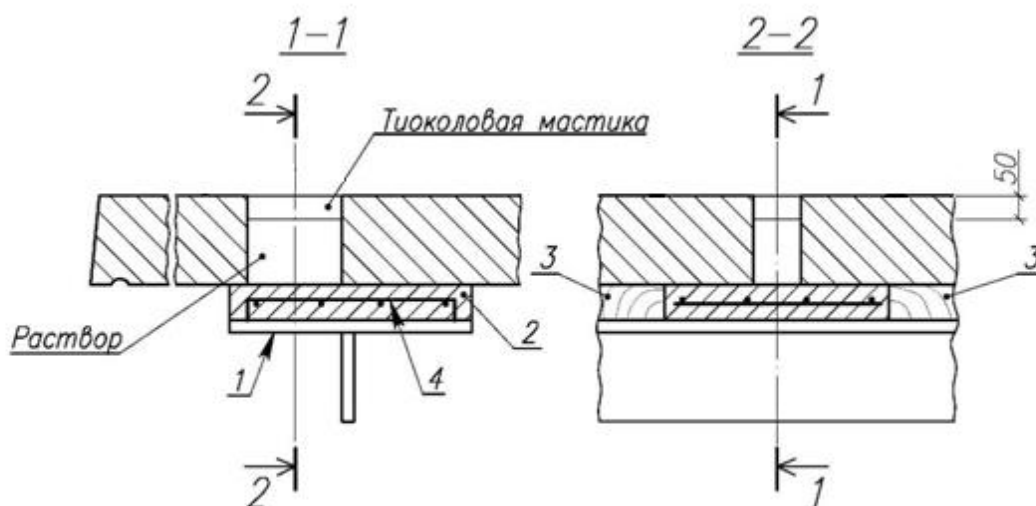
1 - продольная балка; 2 - мелкозернистый бетон (шпильки и заполнение овальных отверстий условно не показано); 3 - деревянная прокладка; 4 - армокаркас.
